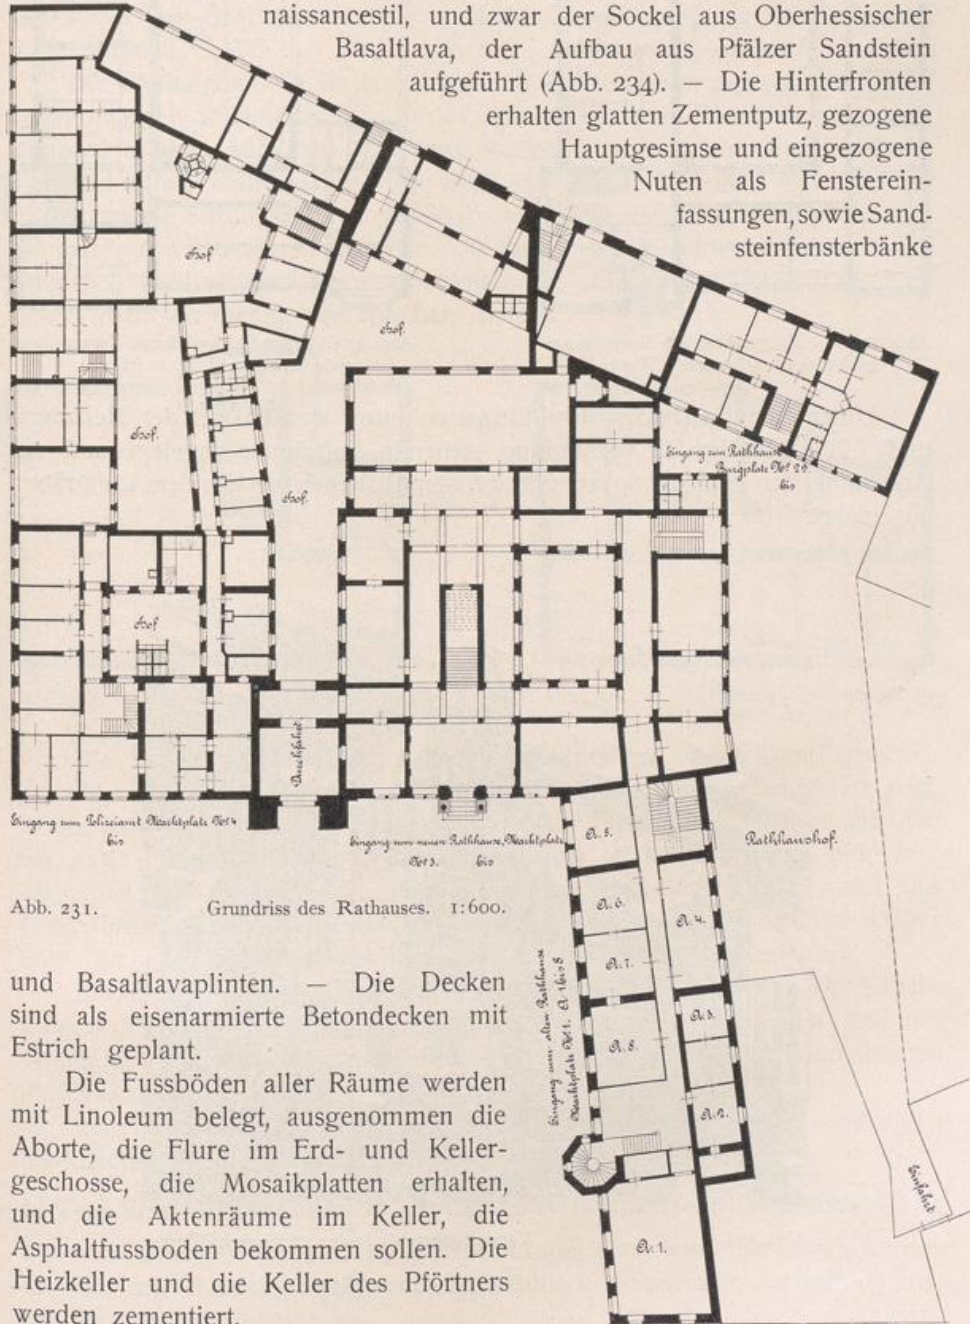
Grundriss des Rathauses. 1:600.
